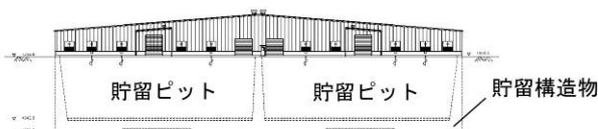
埋立地の形態及び構造（平面図、立面図等）
